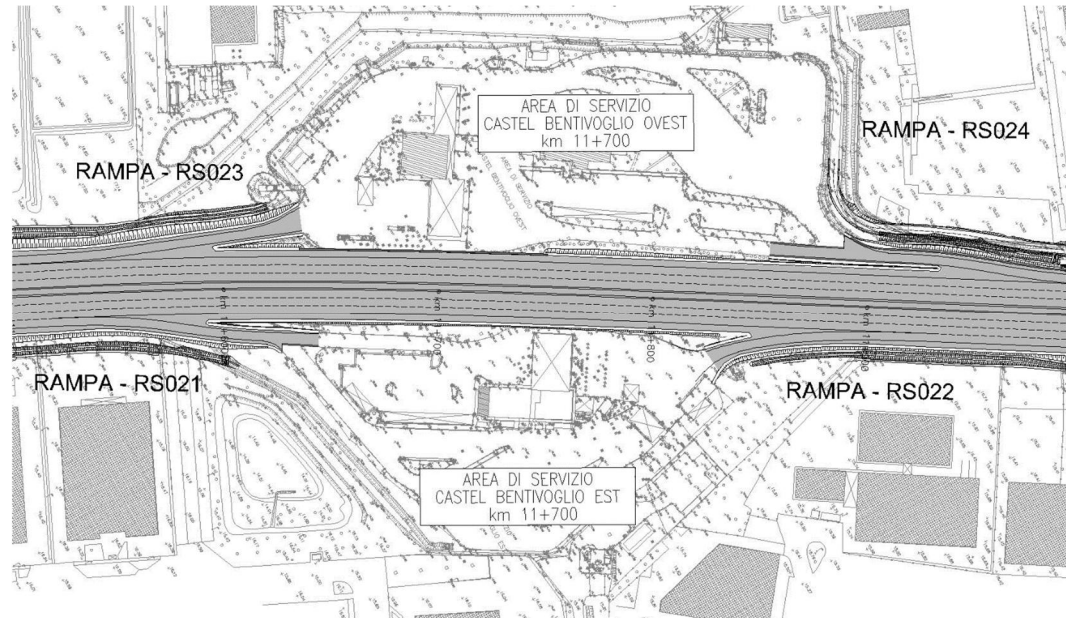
Area di servizio Bentivoglio, stralcio planimetrico di progetto
